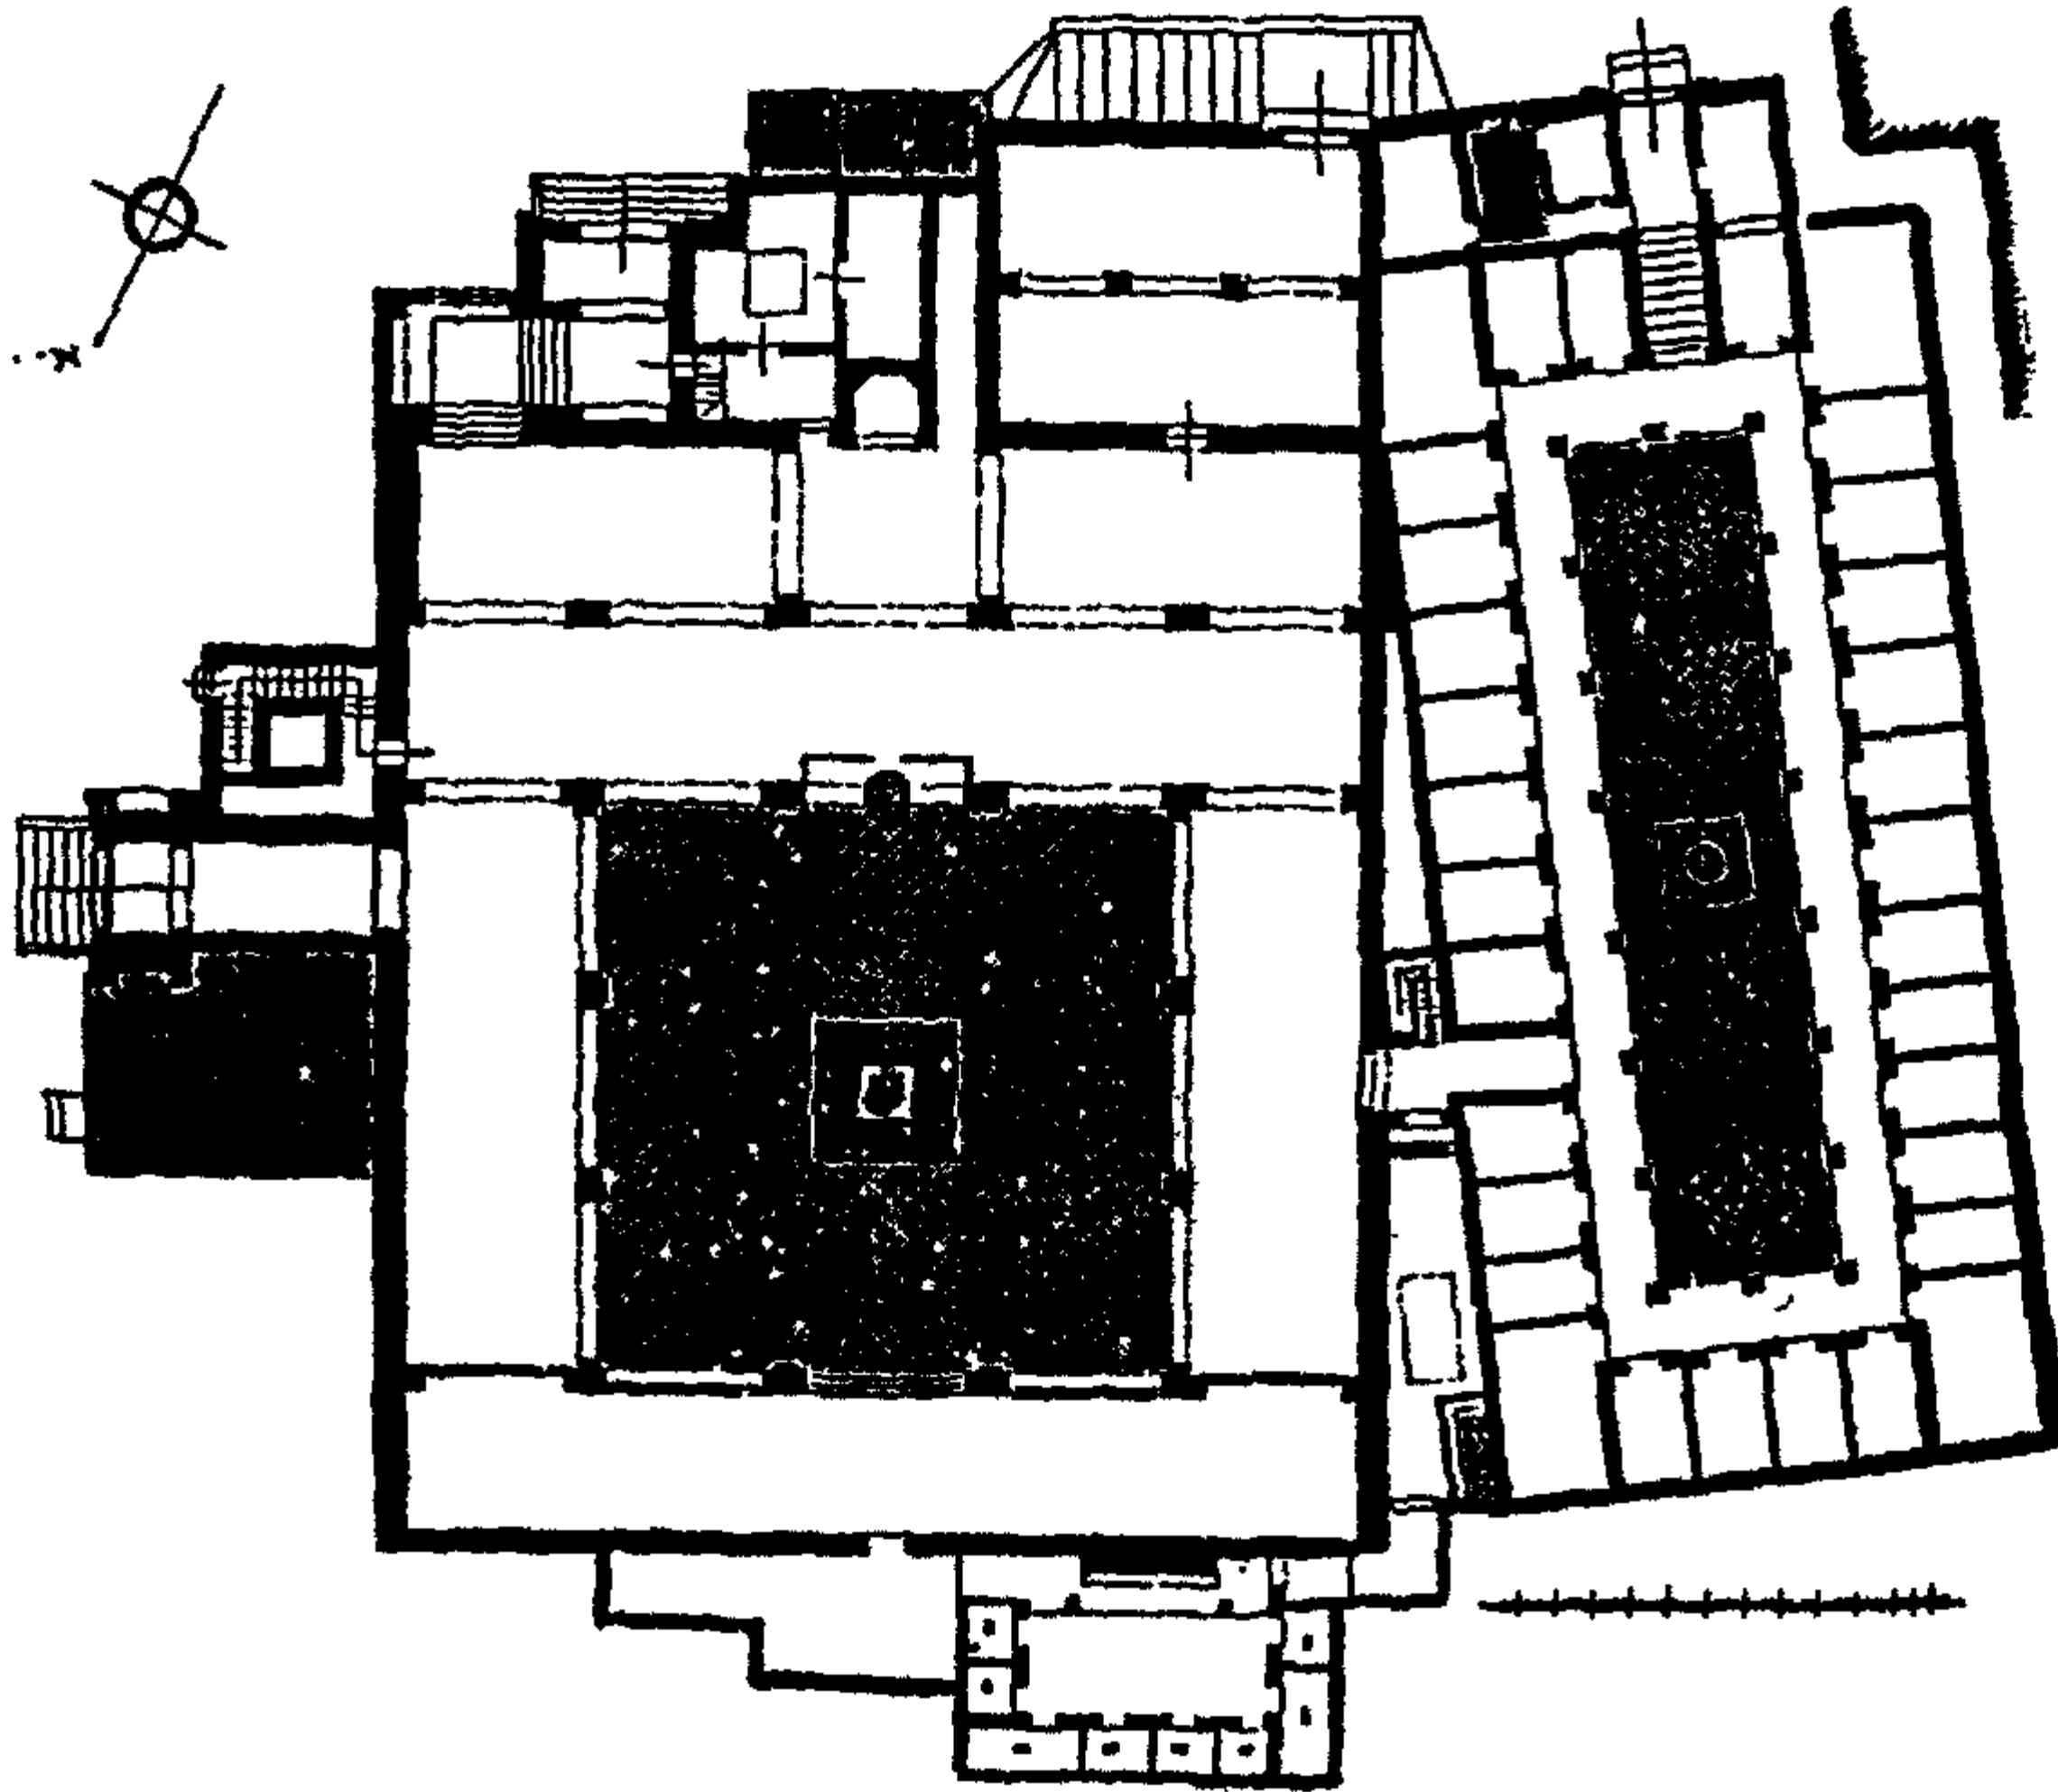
مسقط أفقي للجامع الكبير بفاس الجديد.
